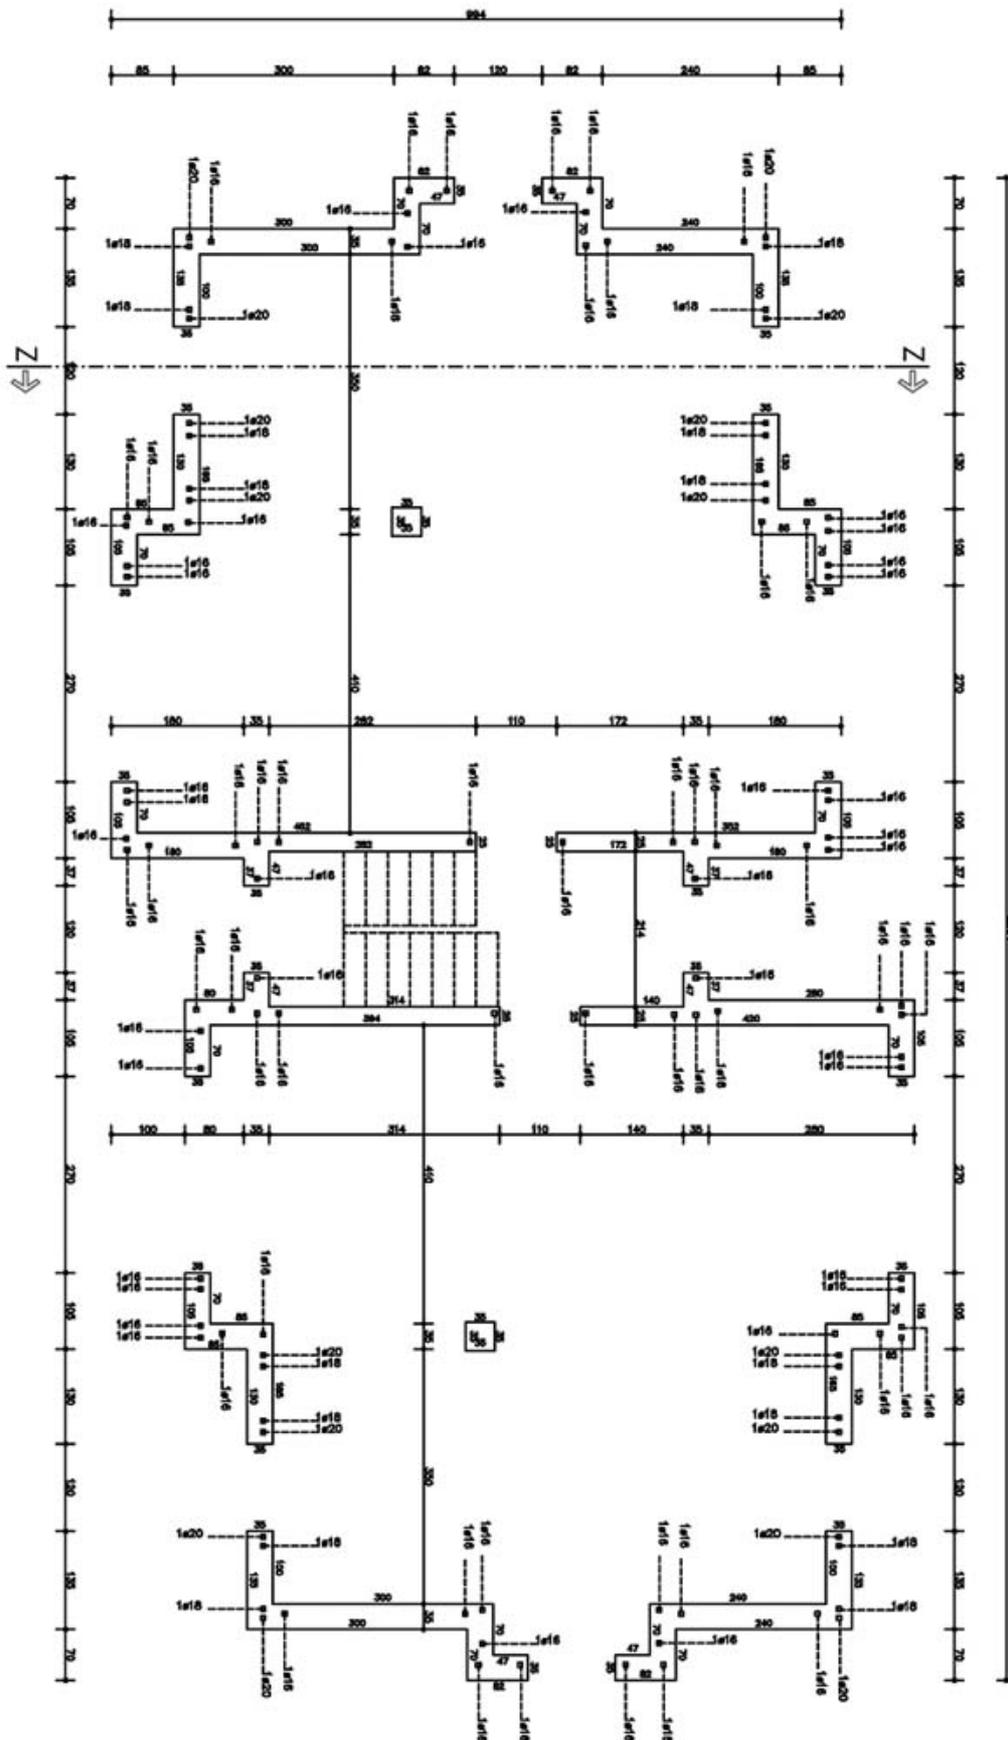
Pianta dei setti in muratura armata del piano terra.
